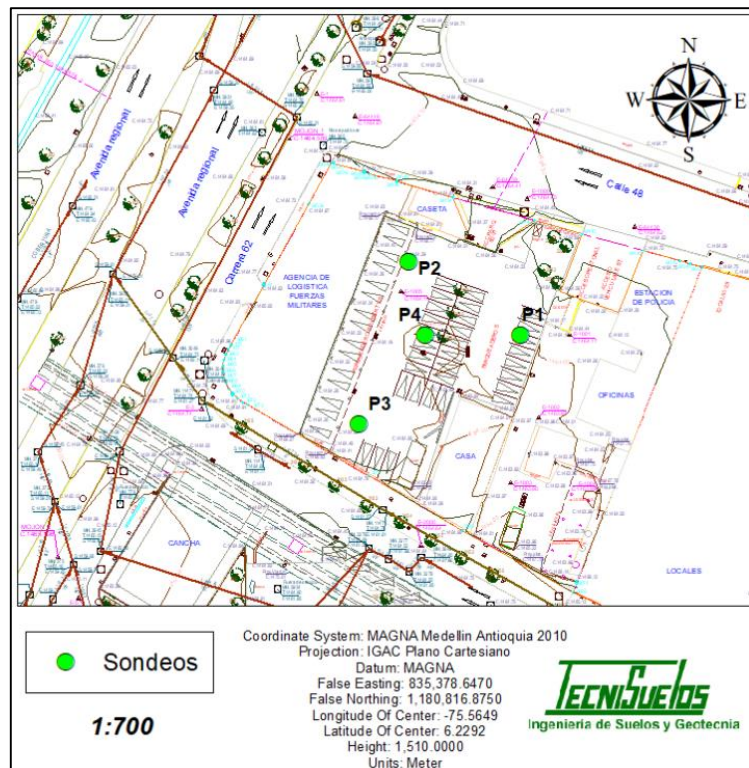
Ubicación de los sondeos sobre la planta del lote en estudio
